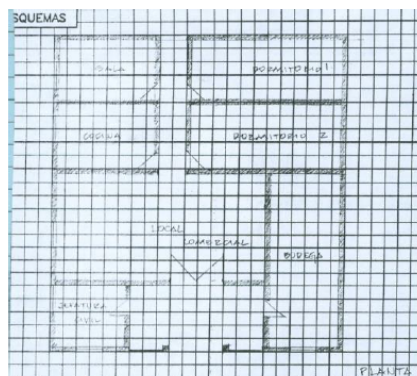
Composición Funcional Planta Baja- Ficha de inventario.
